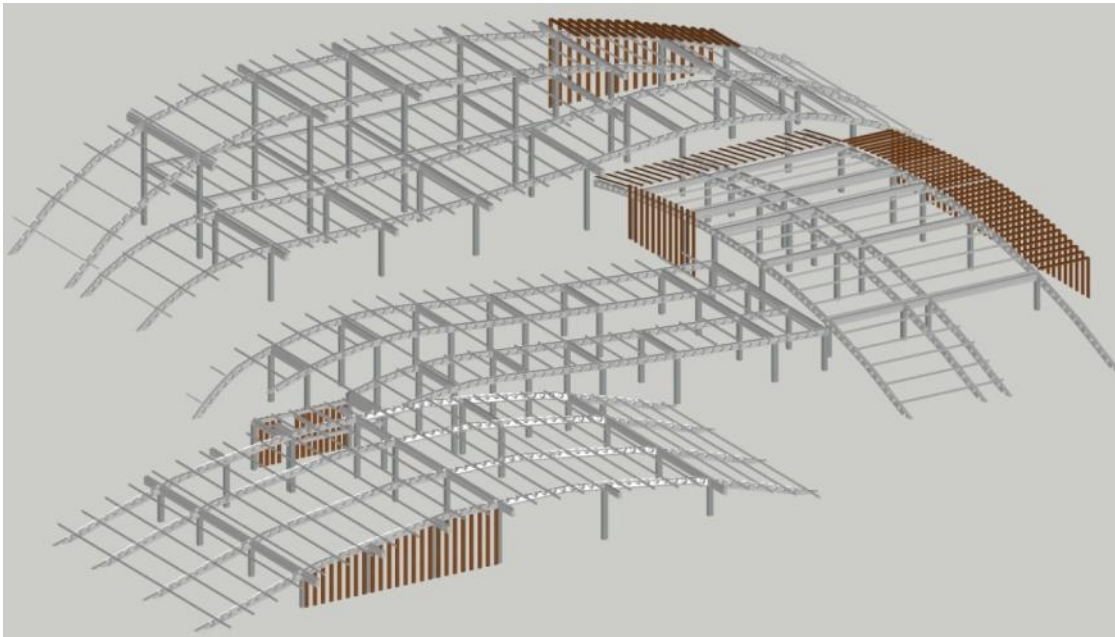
Detalle de estructura del centro botánico y pérgolas. Fuente: Propia
